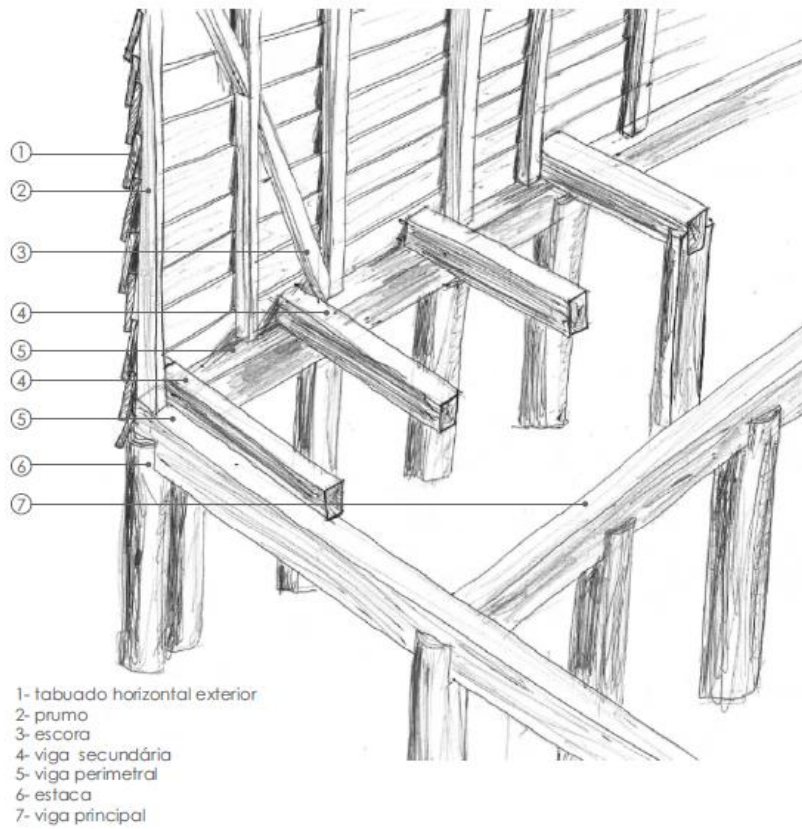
Pormenor tipo do sobrado (fonte: Moutinho (2007))
